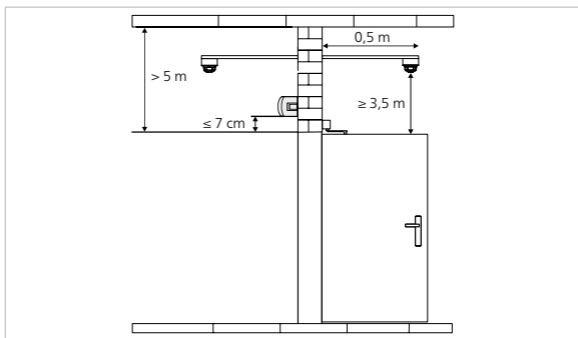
Montagevorgaben mit 2 Decken- oder Kragarmrauchschaltern
